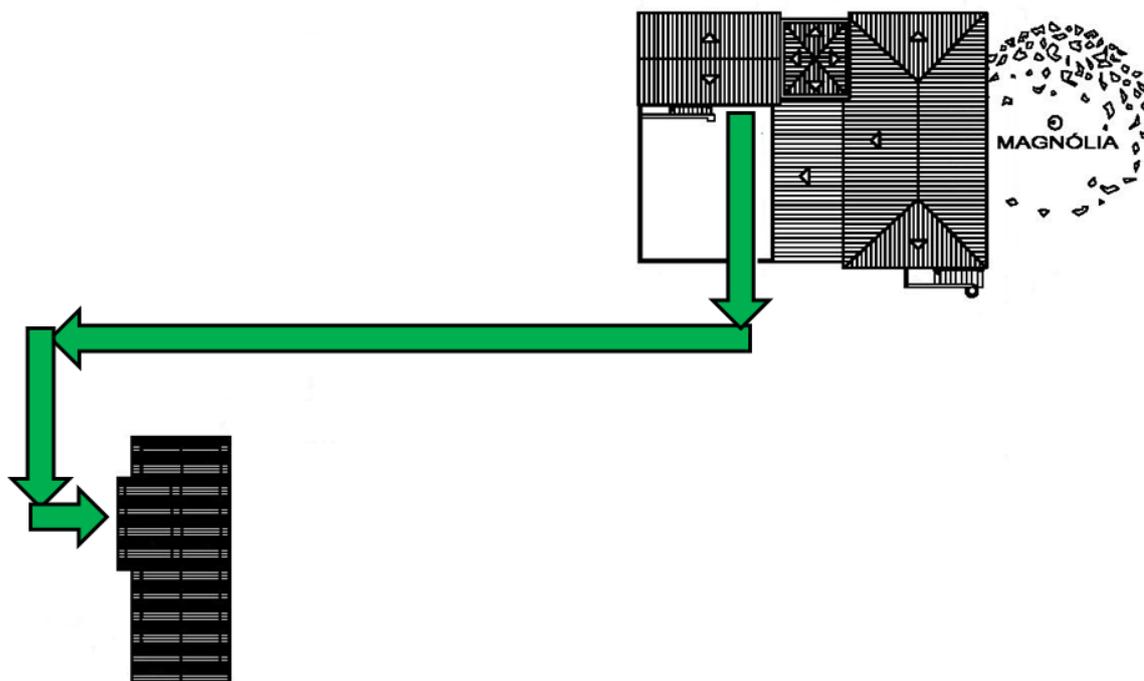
Planta do 1º Pavimento e do Térreo com os caminhos para a evacuação dos acervos.
